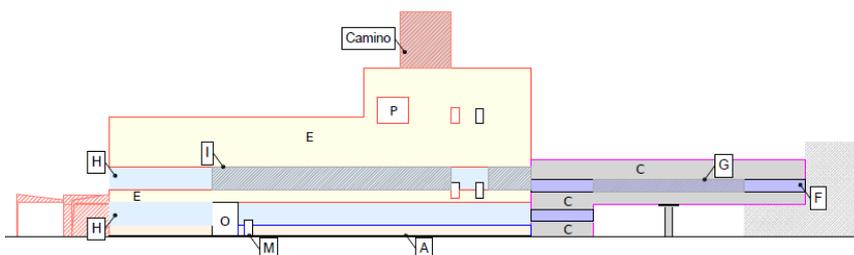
Dettaglio composizione architettonica prospetto sud
